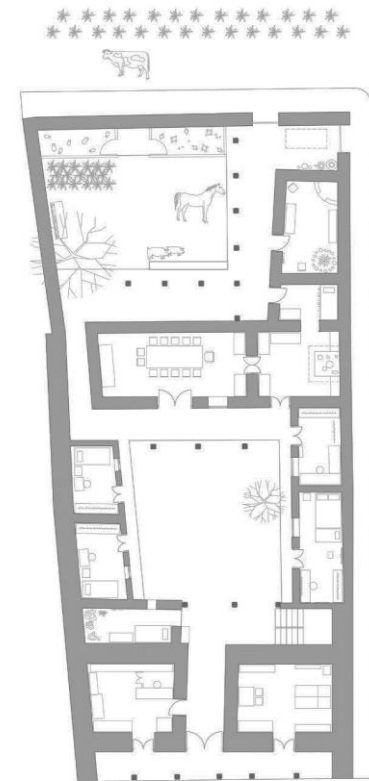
a. Planta colonial reconstruida s/e. Distribución de espacios. Elaboración propia
